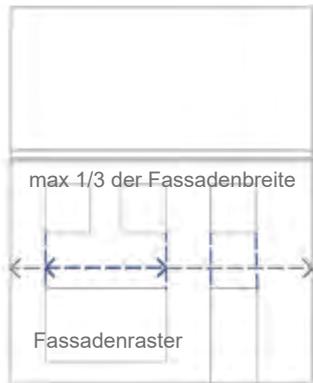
Dimensionierung/Positionierung von Werbeanlagen (Flachwerbung) am Gebäude
